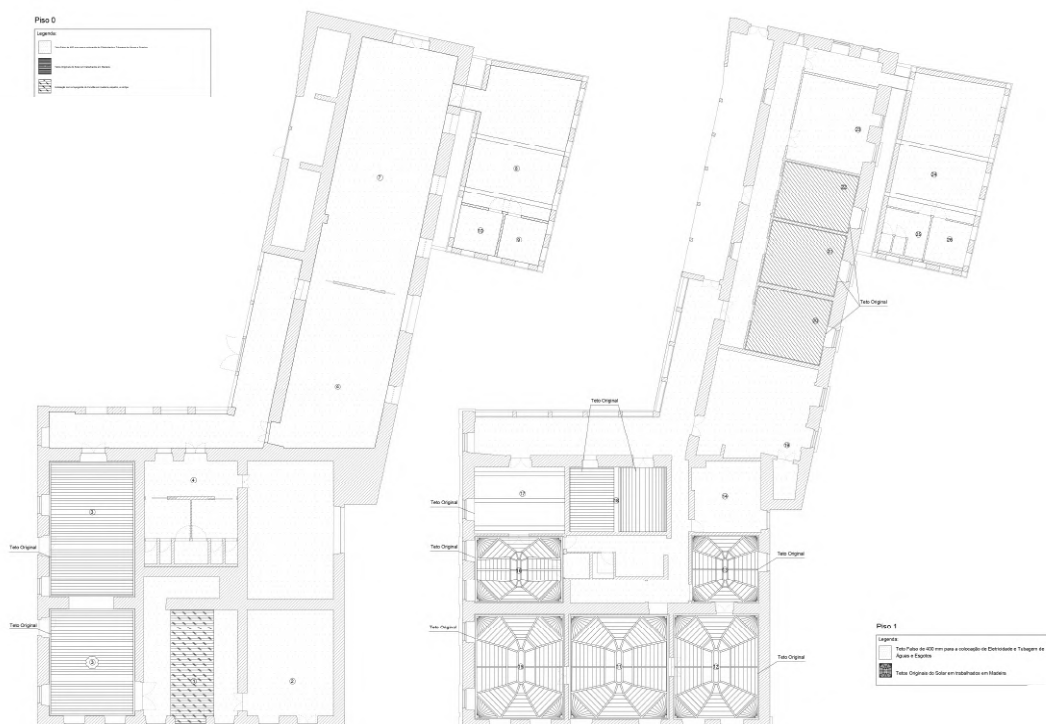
Plantas de Teto- Fonte: Bruna Monteiro
